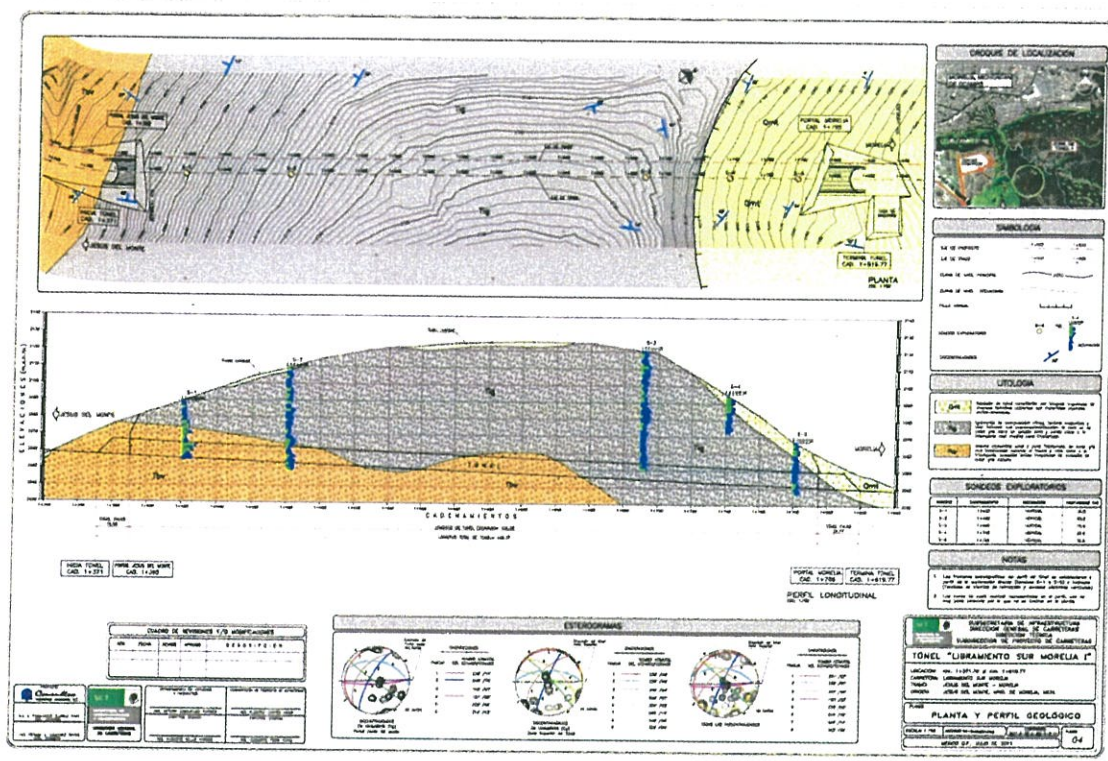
Planta y Perfil Geológico de Detalle del Túnel I
